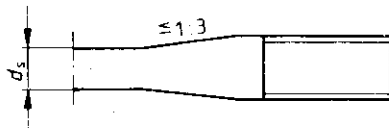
Aufgestauchtes Stabende mit Gewinde für verschraubten Stoß
